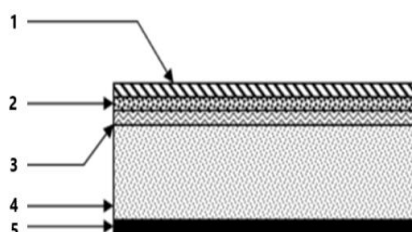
Schéma statique à dalle plain pour les planchers et balcon
